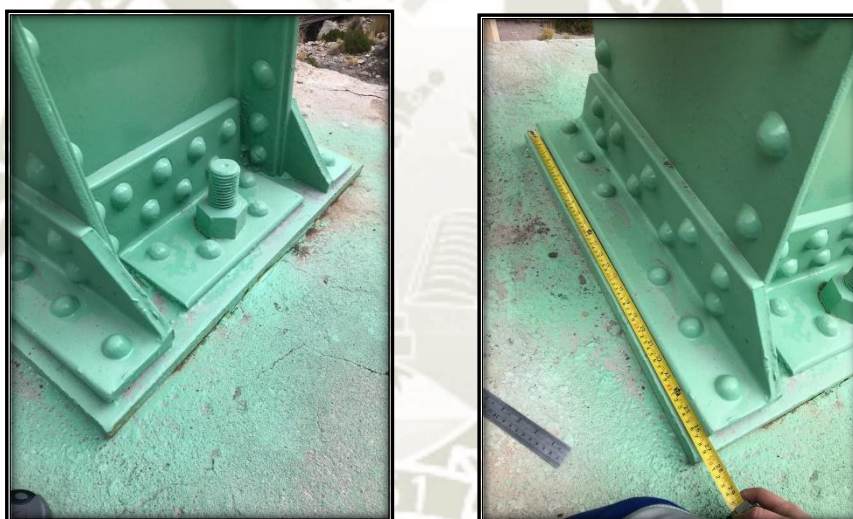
Detalle en planta de columna C1 que llega al pedestal N°07
